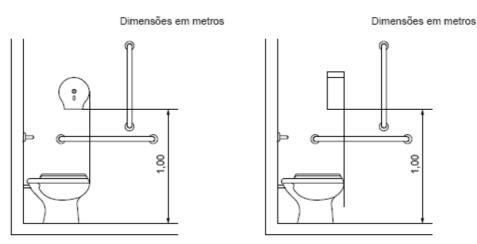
Localização da papeleira de sobrepor (rolo) – Vista lateral
